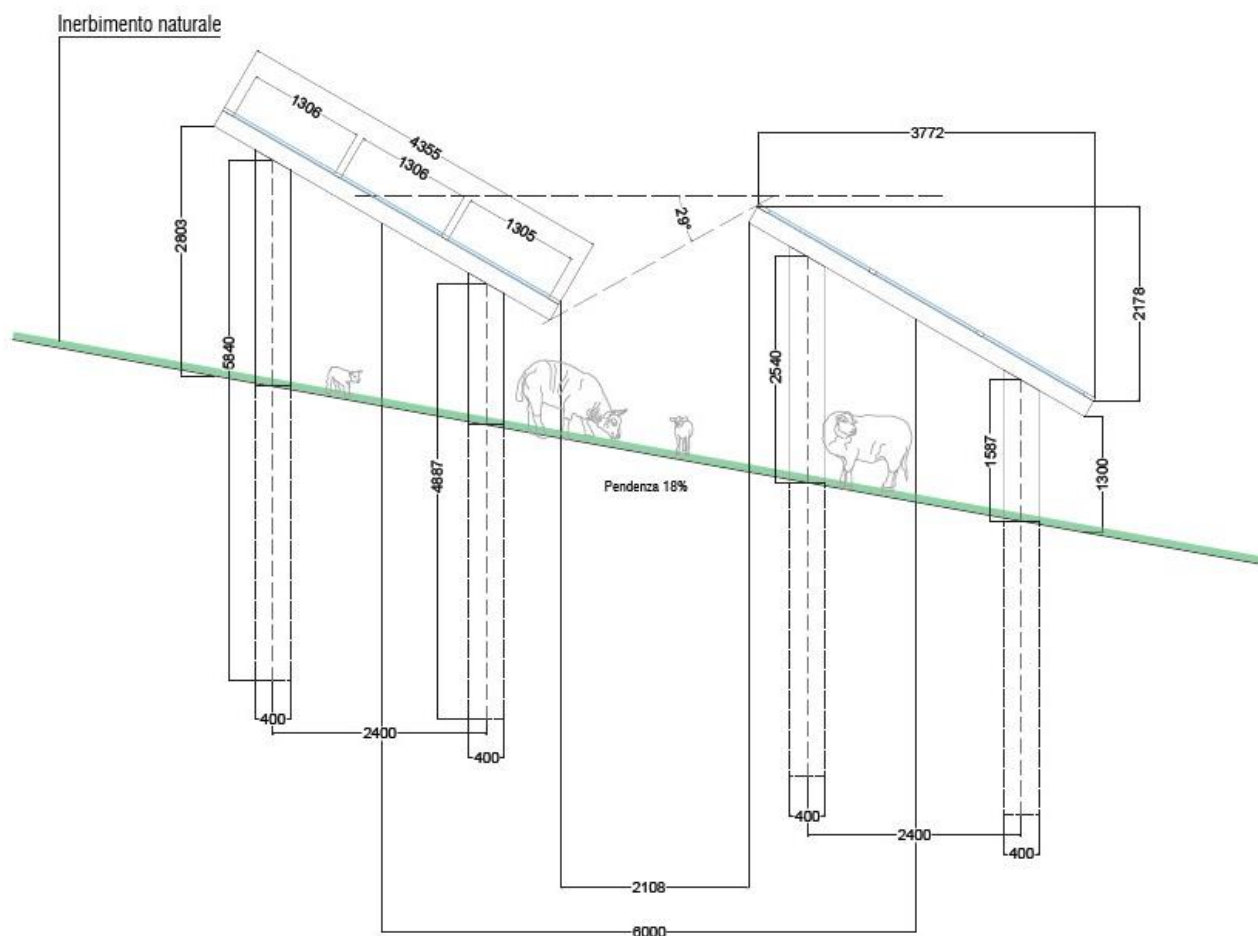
Sezione trasversale stringhe a telaio fisso in area ad attività zootecnica
